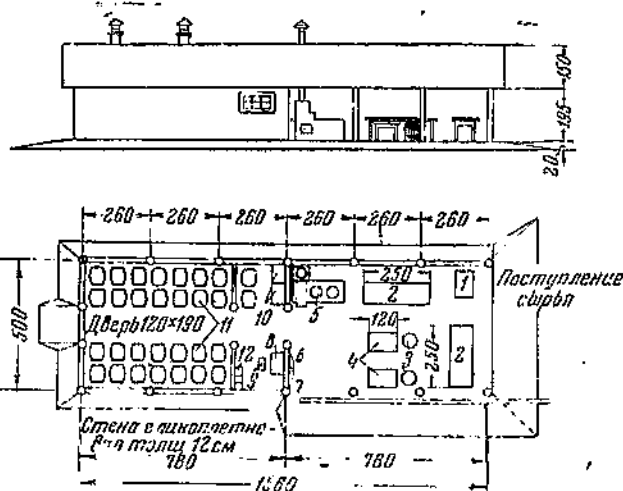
Общий вид и план улучшенного грибоварочного пункта: 1—весы; 2—стол для сортировки и очистки грибов; 3—окоренки для мойки грибов; 4—решетки грохота; 5—очаг на два котла; 6—рукомойник; 7—огнетушитель; 8—стол; 9—табуретка; 10—дверь с отделениями; 11—бочки; 12—шкафчики для спецодежды
